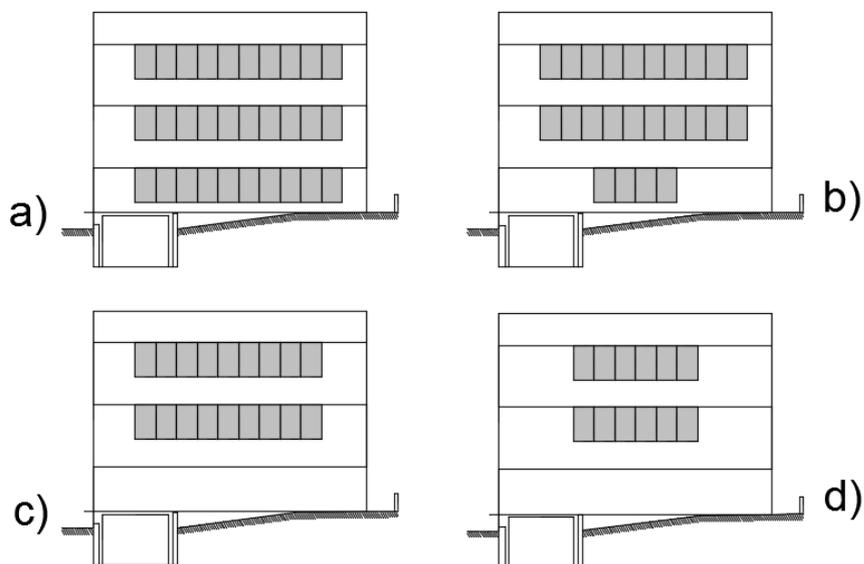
Esquema para os painéis fotovoltaicos na fachada (a - 30 painéis; b - 24 painéis; c - 18 painéis e d - 12 painéis)
